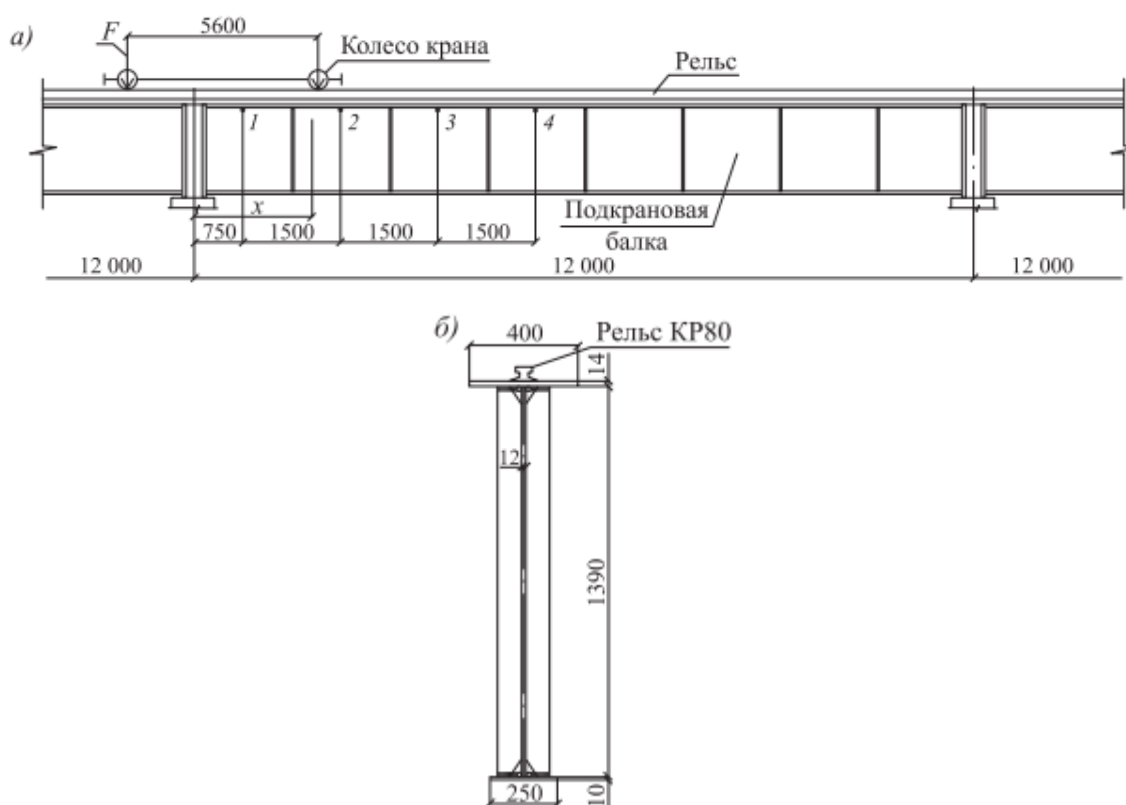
Расчетная схема (а) и сечение (б) типовой подкрановой балки [7]
